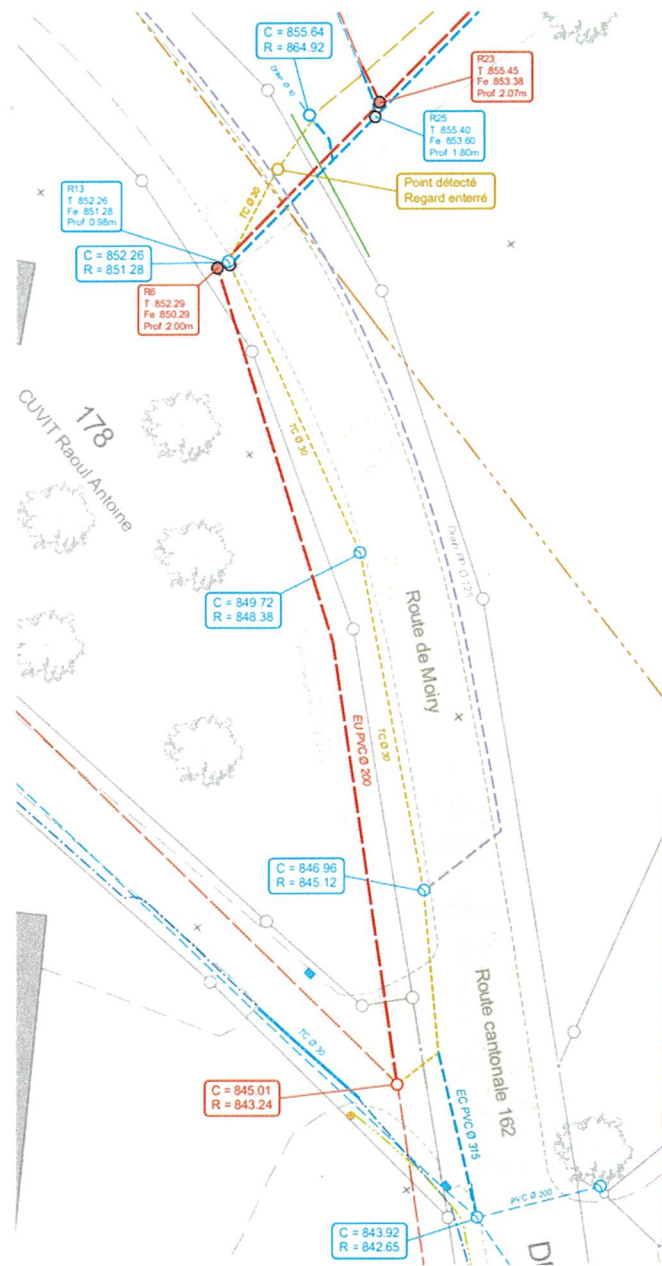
Extrait de plan - zone réfectionnée sur la route de Moiry
